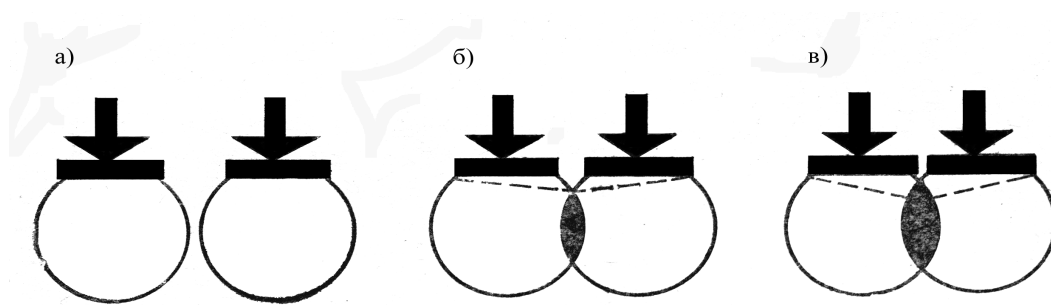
Взаємний вплив двох фундаментів будівель: а – зони напруг не перекриваються; б, в – зони напруг перекриваються
